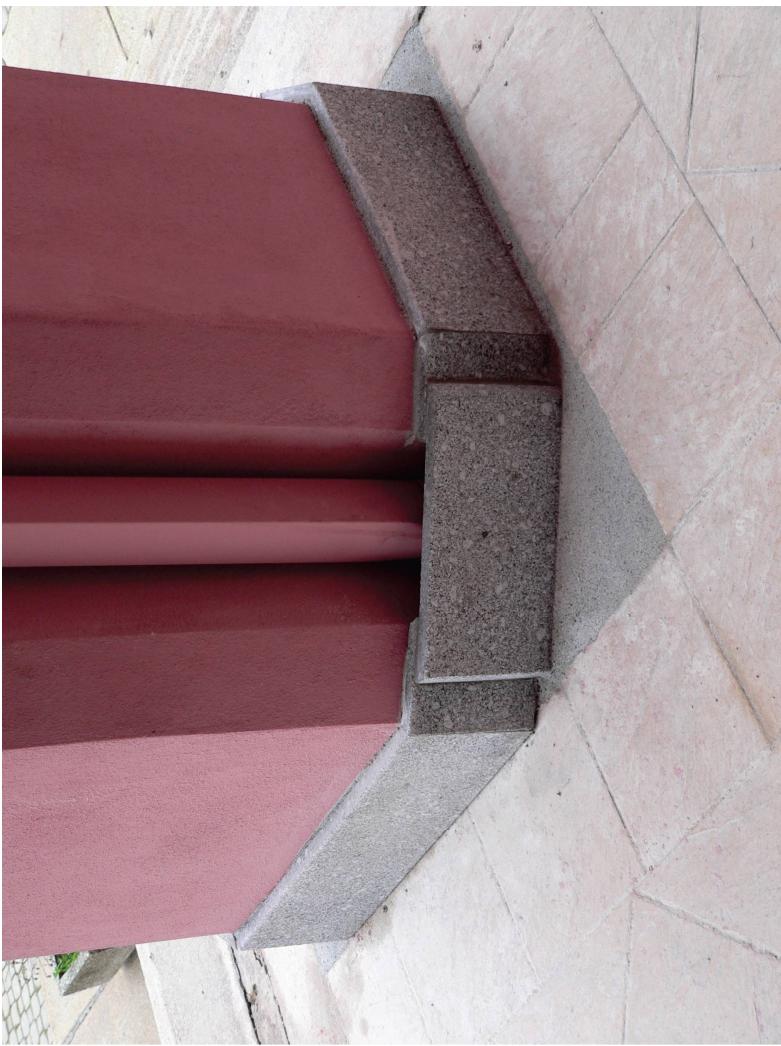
DETAIL OPRAVY SOKLŮ U DEŠŤOVÝCH SVODŮ _ JIŽNÍ FASÁDA _ KA/35
